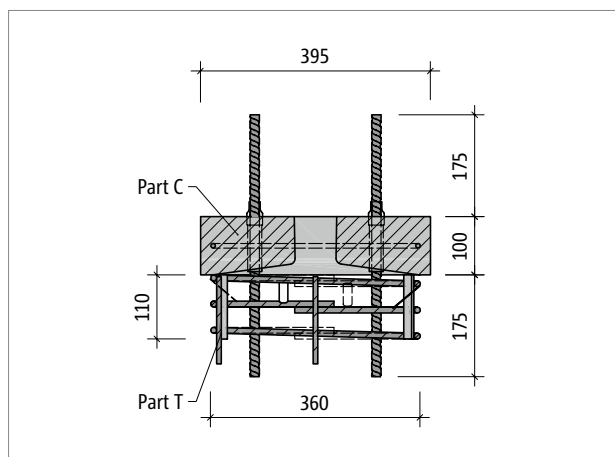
Schöck Sconnex® type P-B400: Aanzicht van bovenaf
